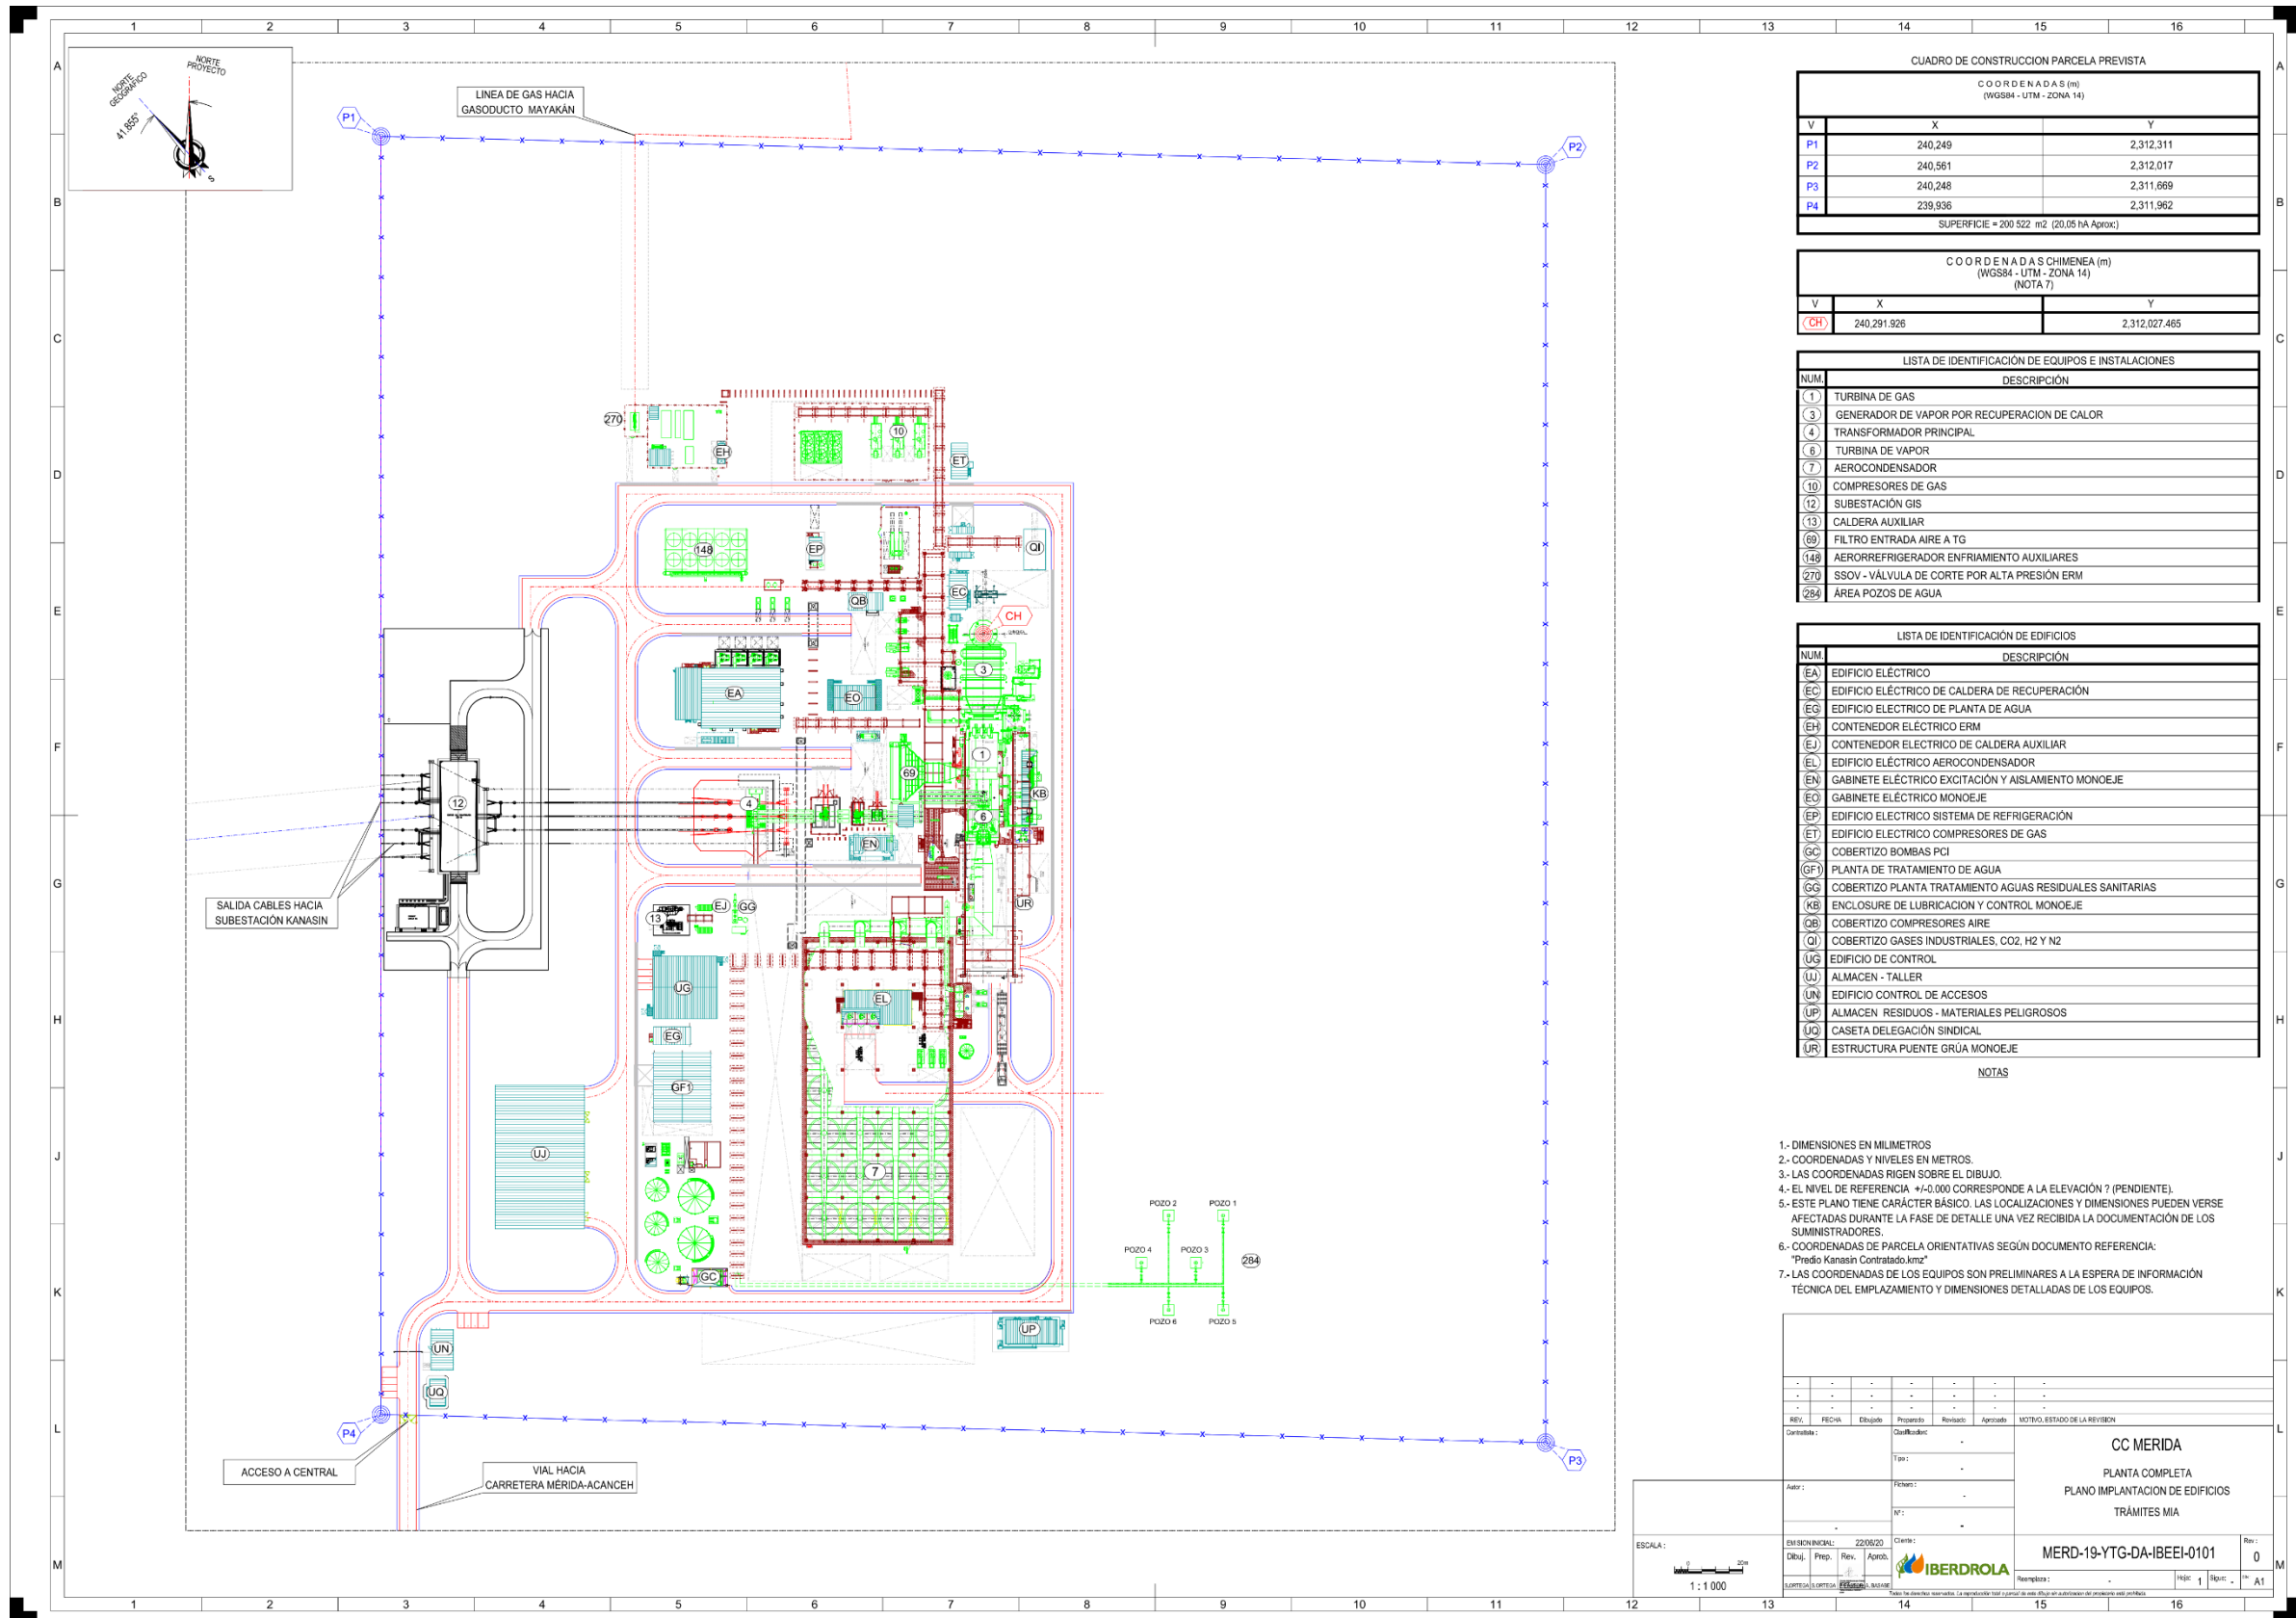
Plano de conjunto de las instalaciones dentro de la central.
